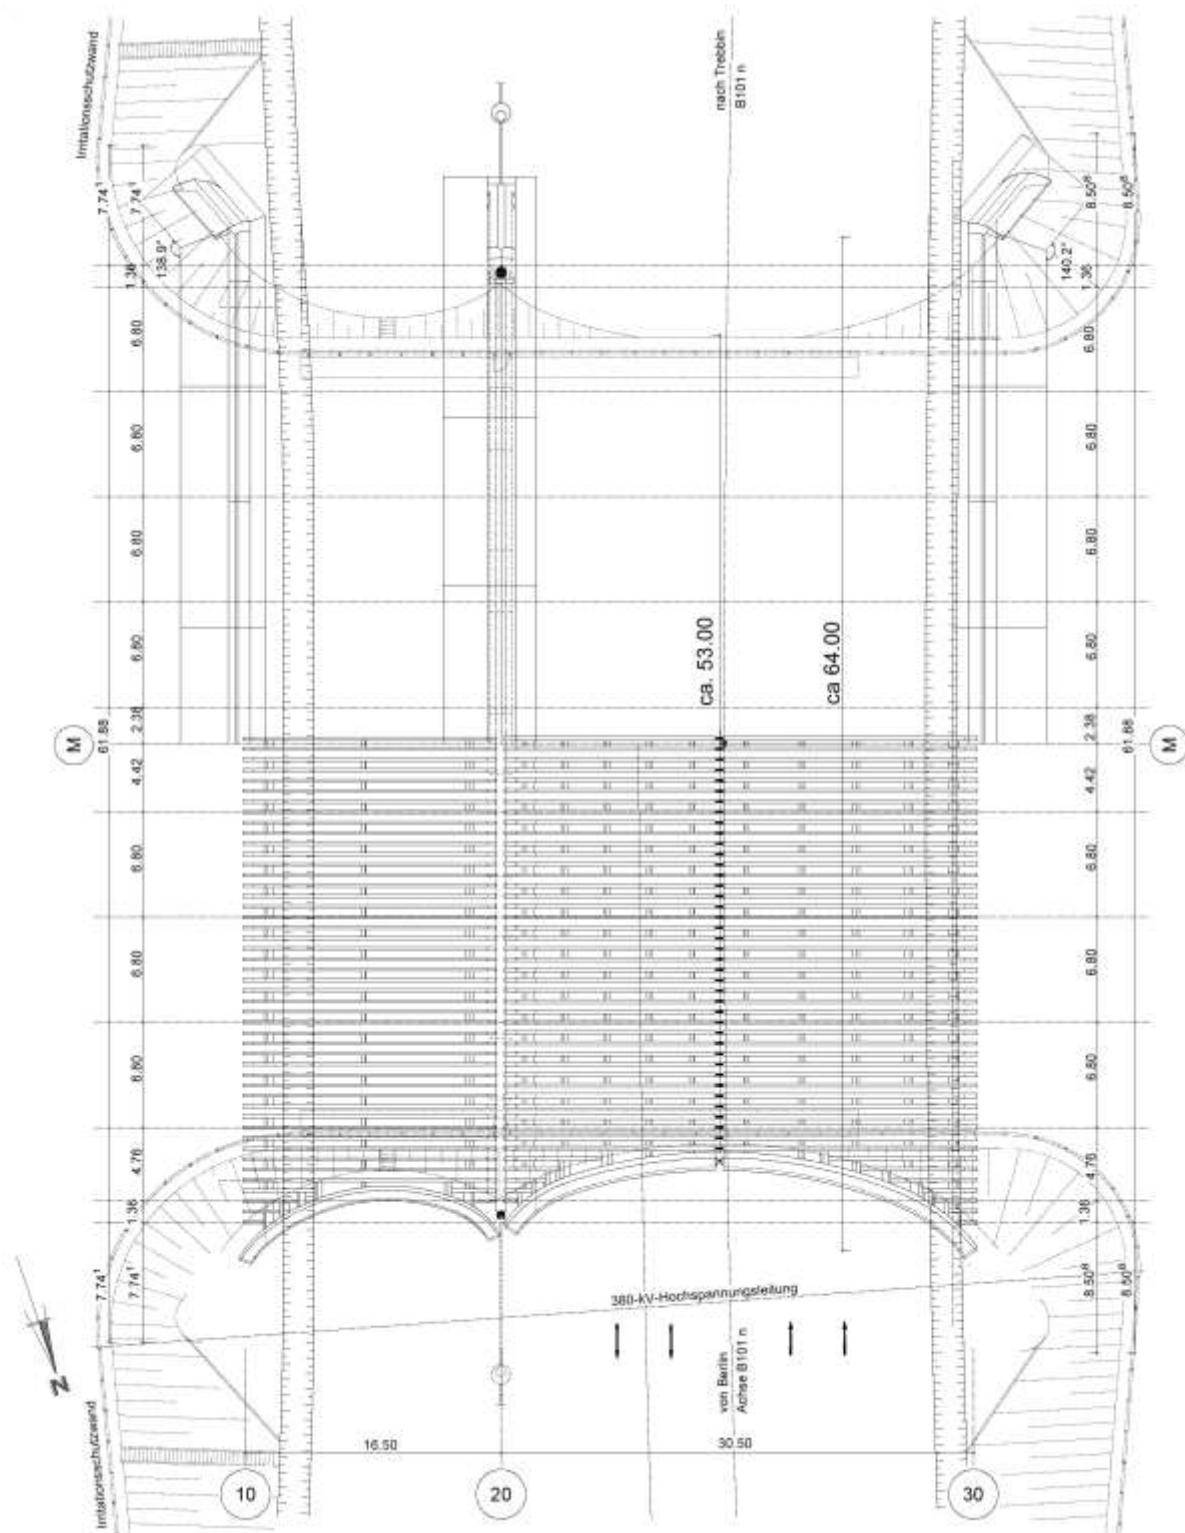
Grundriss der Grünbrücke Thyrow
